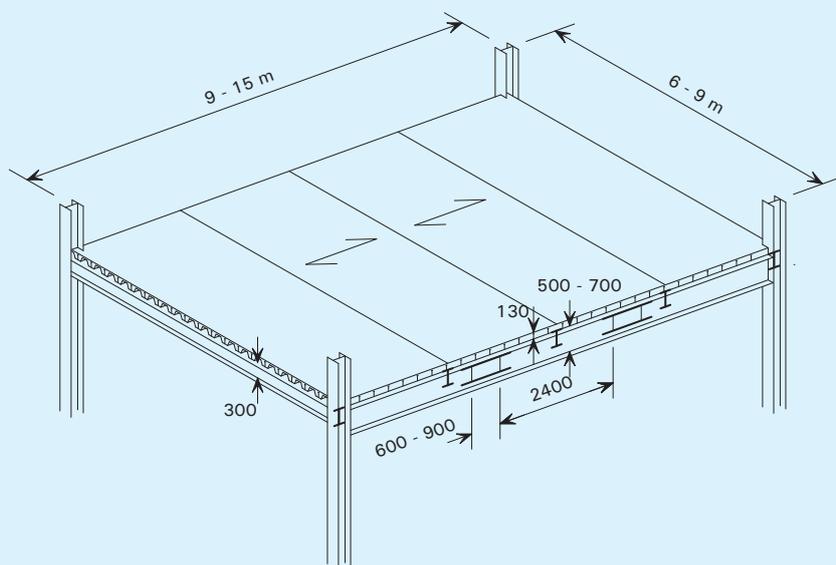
Пример перекрытия с большепролетными главными балками и второстепенными балками меньшего пролета (указан пролет настила)
